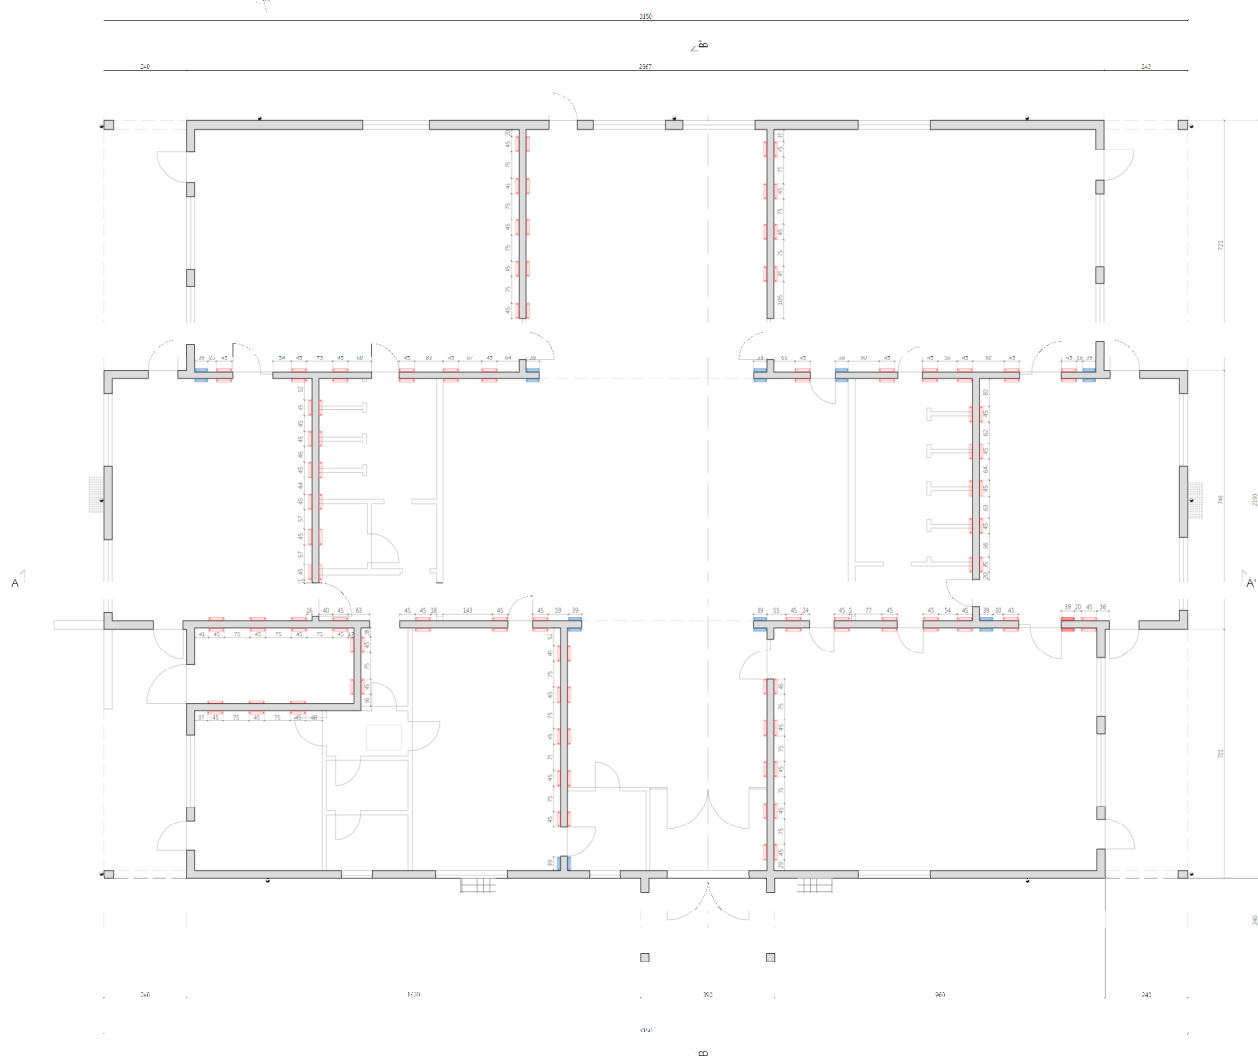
schema tipologico della disposizione degli elementi di rinforzo al piano terra
